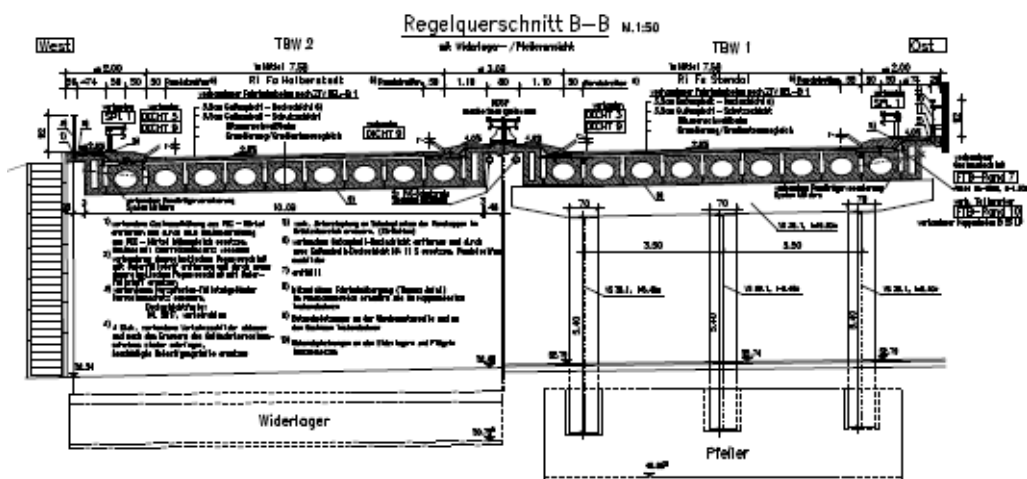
Beispiel: Straßenbrücke Magdeburger Ring über die Liebknechtstraße 2 Teilbauwerke nebeneinander Teilbauwerk TBW 1 führt in Richtung Stendal TBW 2 in Richtung Halberstadt
